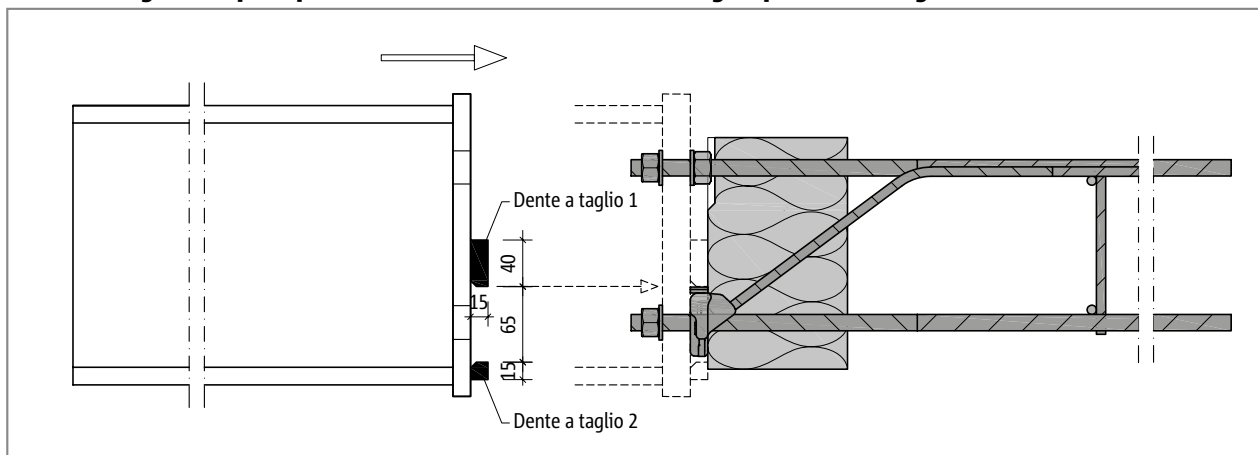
Schöck Isokorb® XT tipo SK: posa della trave in acciaio
